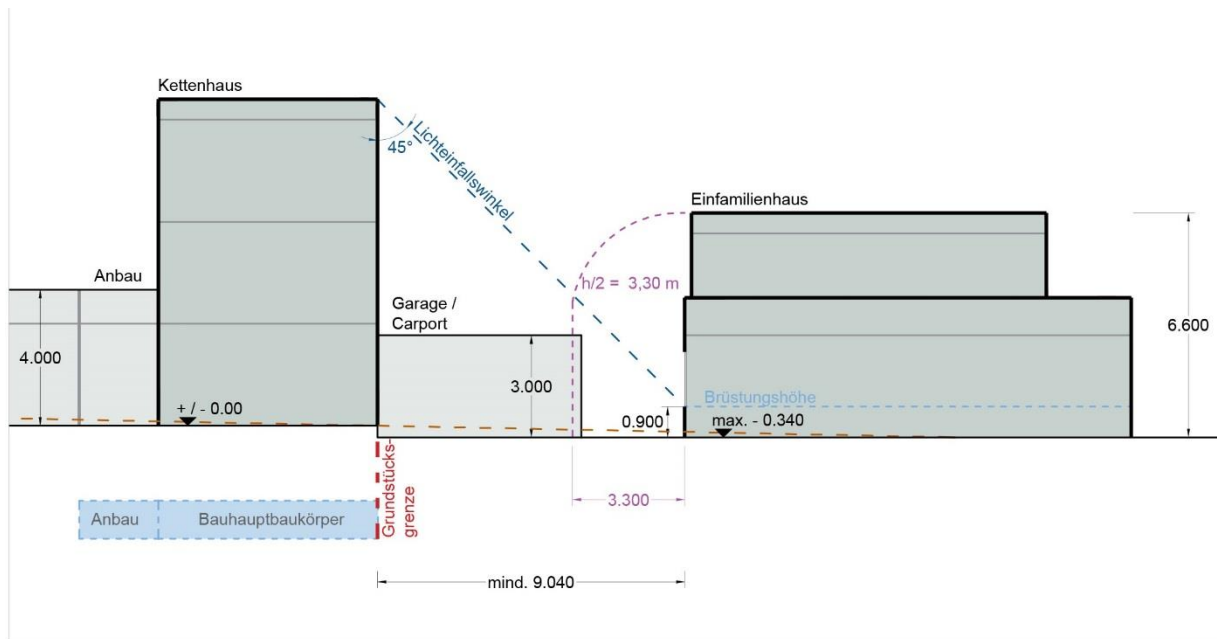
Schnittansicht Kettenhaus/ Einfamilienhaus – Garage/ Carport mit Grenzanbau zum Kettenhaus, o. M.
